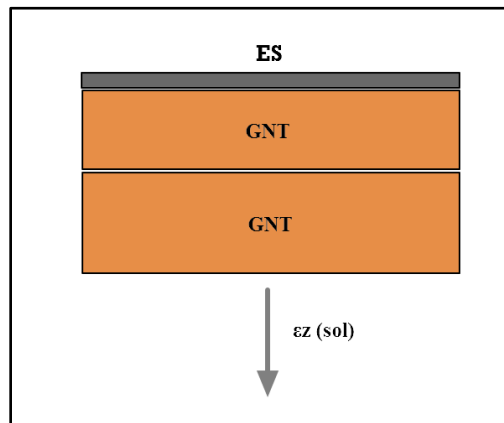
Mode de fonctionnement de la structure de chaussée adopté
